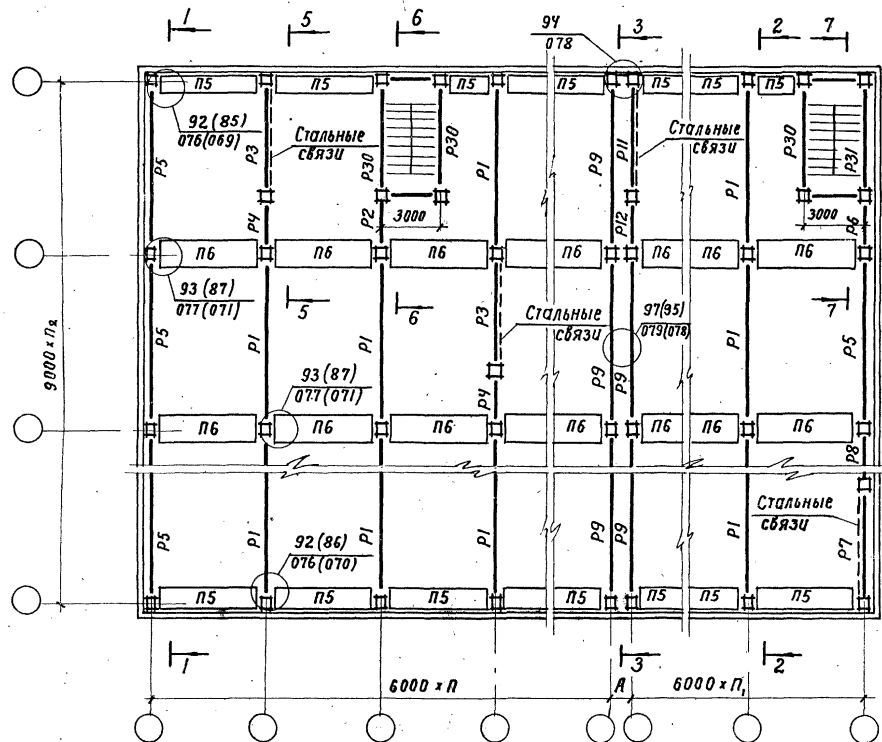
Схема расположения ригелей и связевых плит в покрытиях зданий с сеткой колонн 9×6 м
